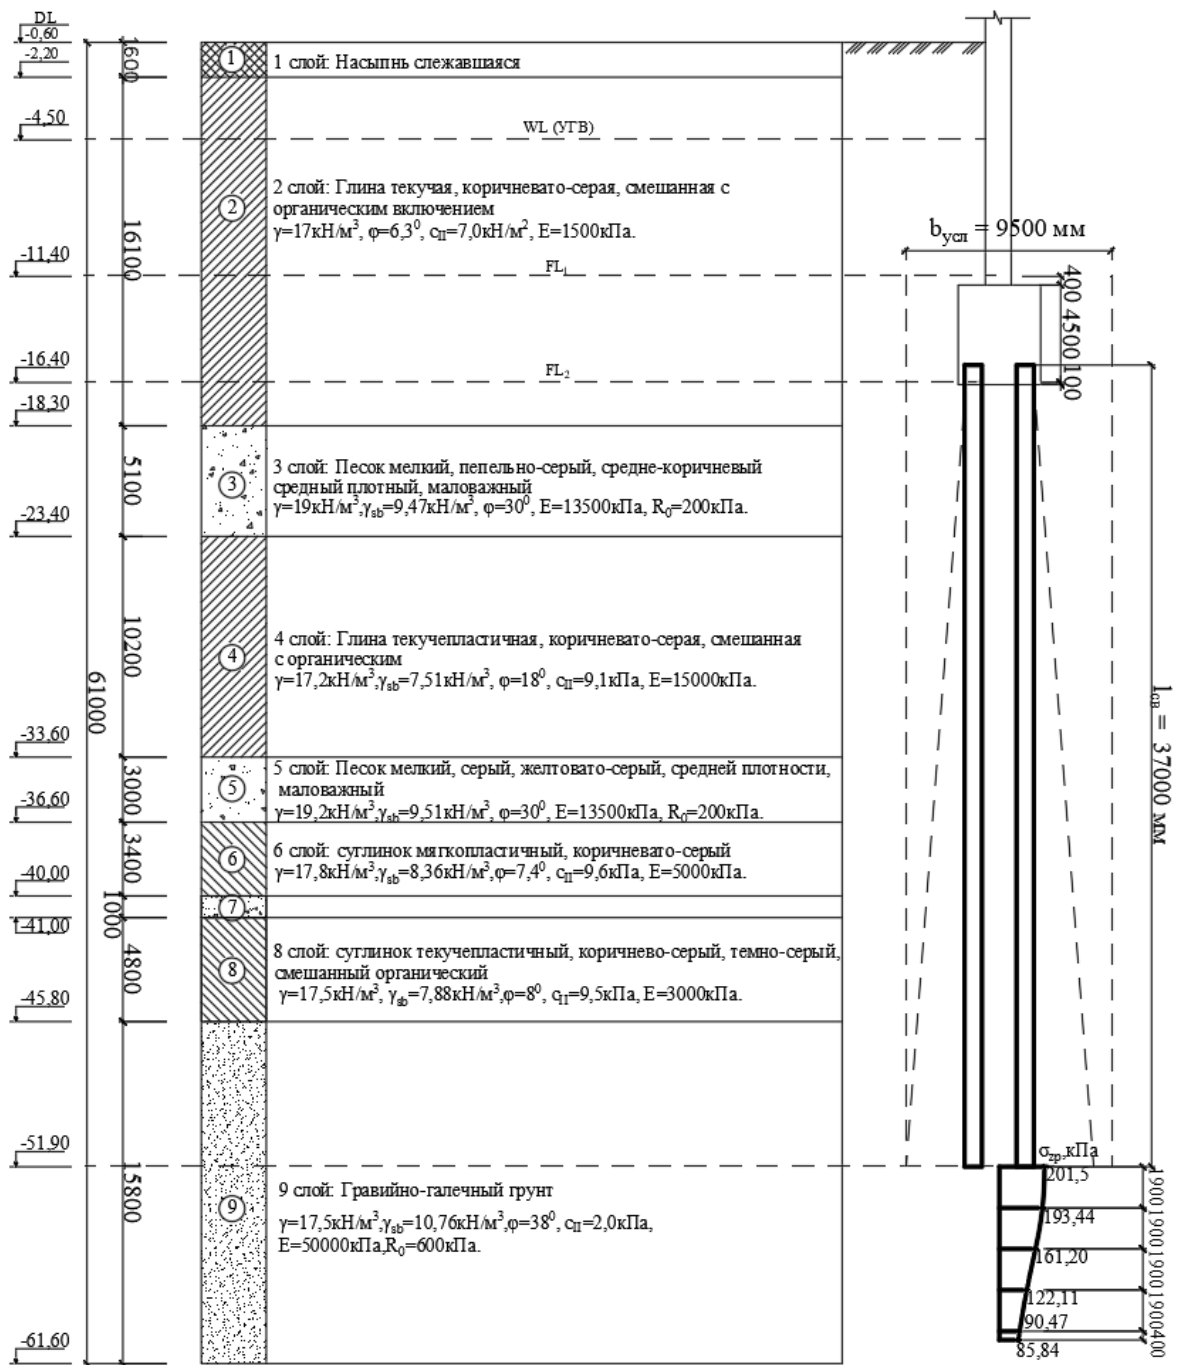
Расчетная схема для определения осадки свайного фундамента
